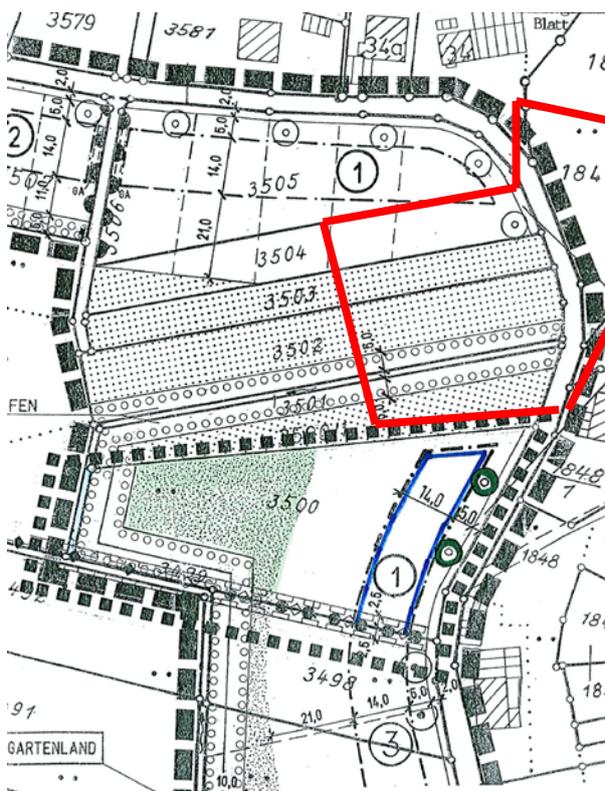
Bebauungsplan „Schlauch II, 1. Änderung“ (2001)
